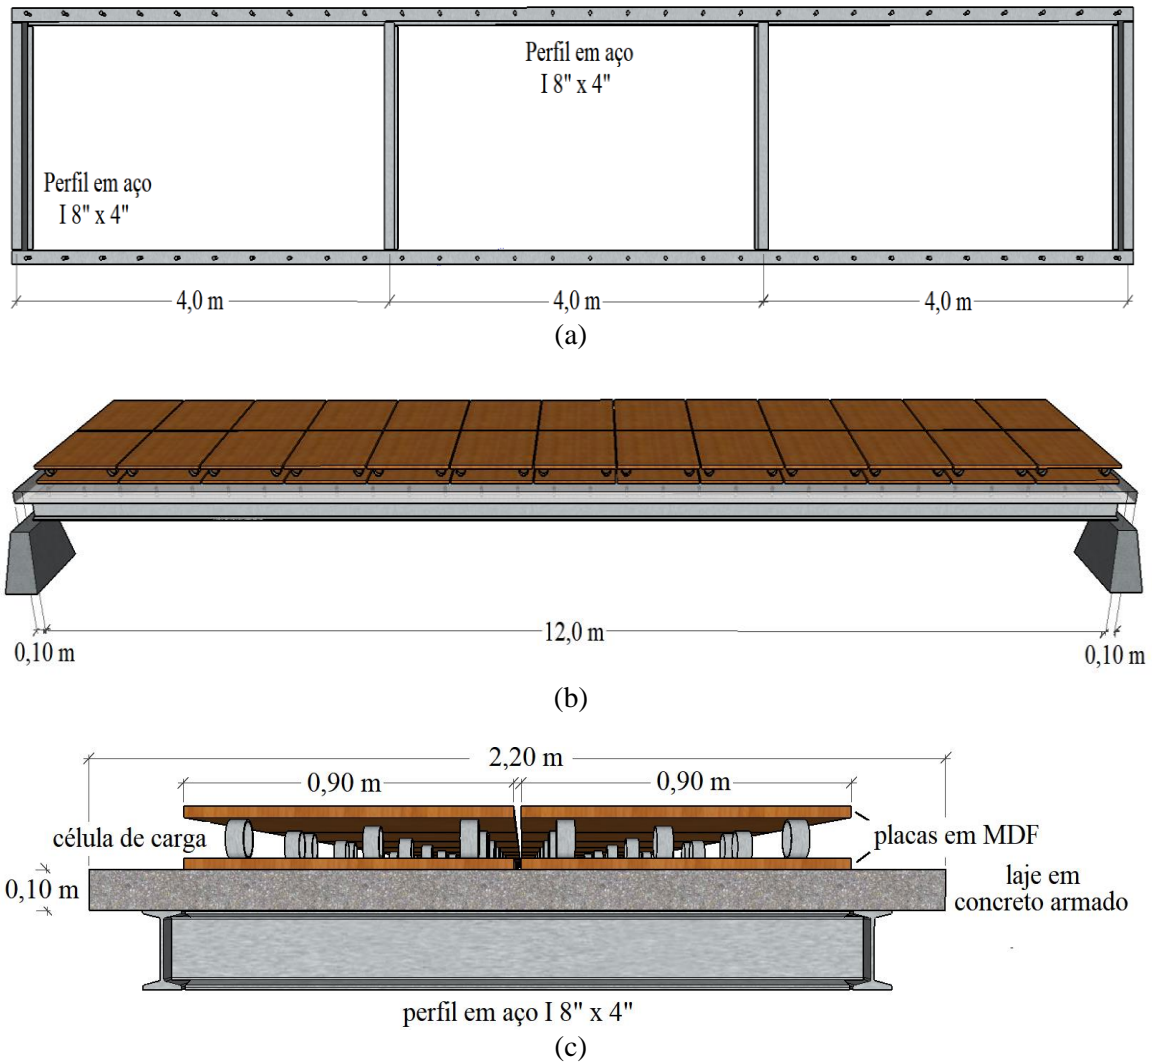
Estrutura de passarela: (a) Vista superior perfil de aço; (b) Seção longitudinal; (c) Seção transversal
